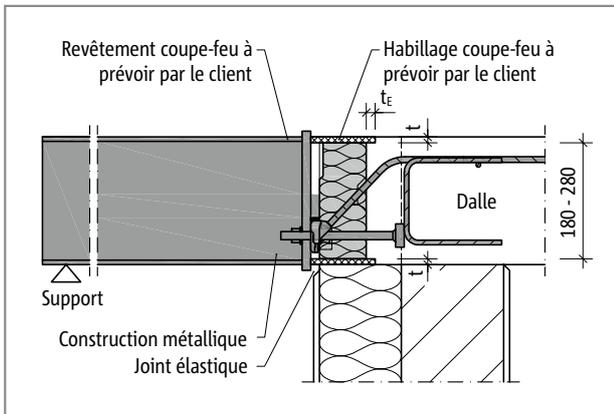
Schöck Isokorb® T type SQ : Bardage de protection incendie sur site - T type SQ, construction en acier avec revêtement de protection incendie ; coupe
